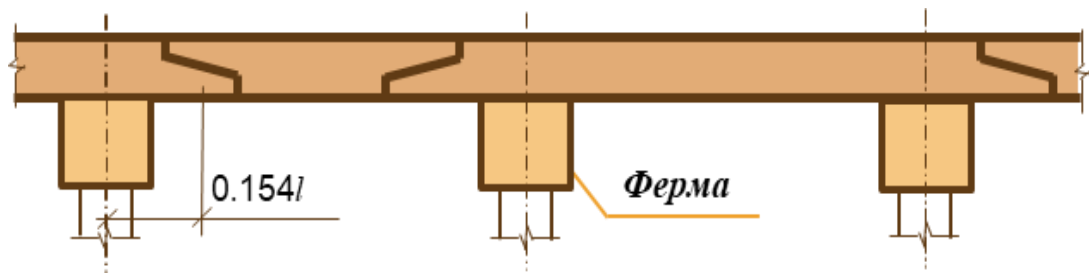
Схема и конструкция консольно-балочного прогона
